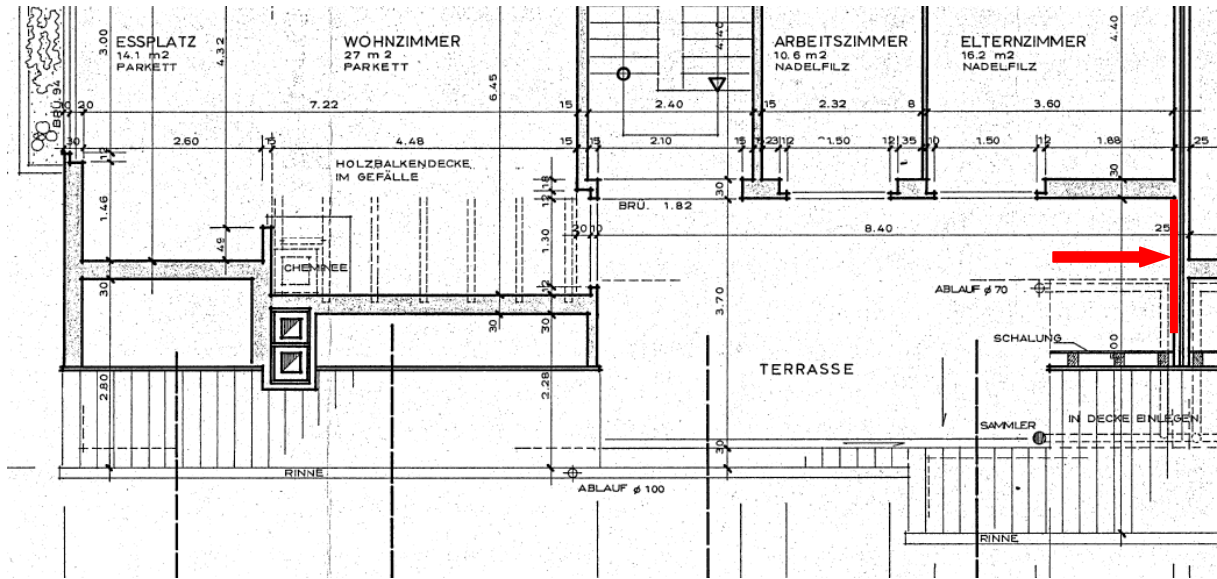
Grundriss Riss Gebäudetrennwand Bereich Terrasse Dachgeschoss
